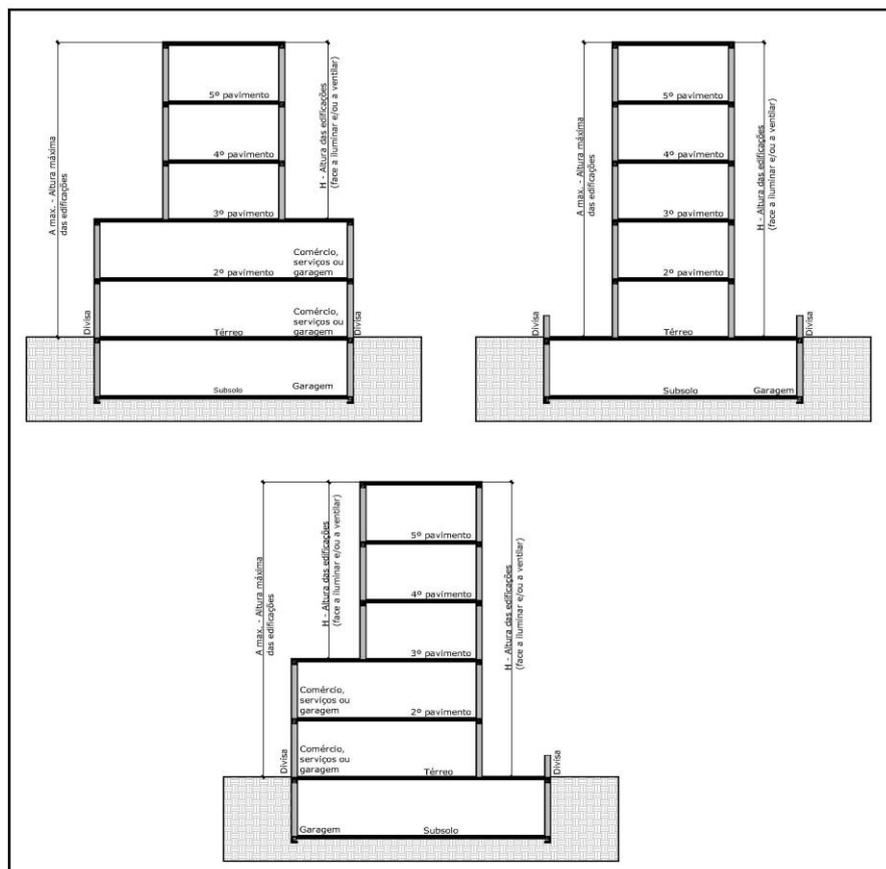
Afastamento em pavimentos destinados a garagem, comércio ou serviço.
